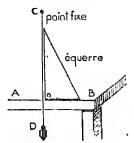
Une verticale monte droit vers le haut sans pencher ni a droite, ni à gauche. Une horizontale reste partout à la même hauteur sur toute sa longueur.
